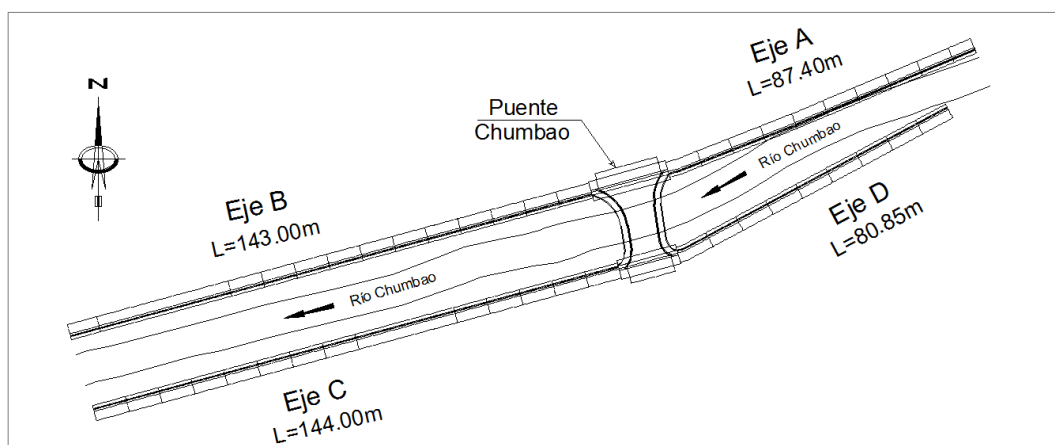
Vista en planta del puente Chumbao, ubicación de los muros de encauzamiento y protección sobre el río Chumbao.
